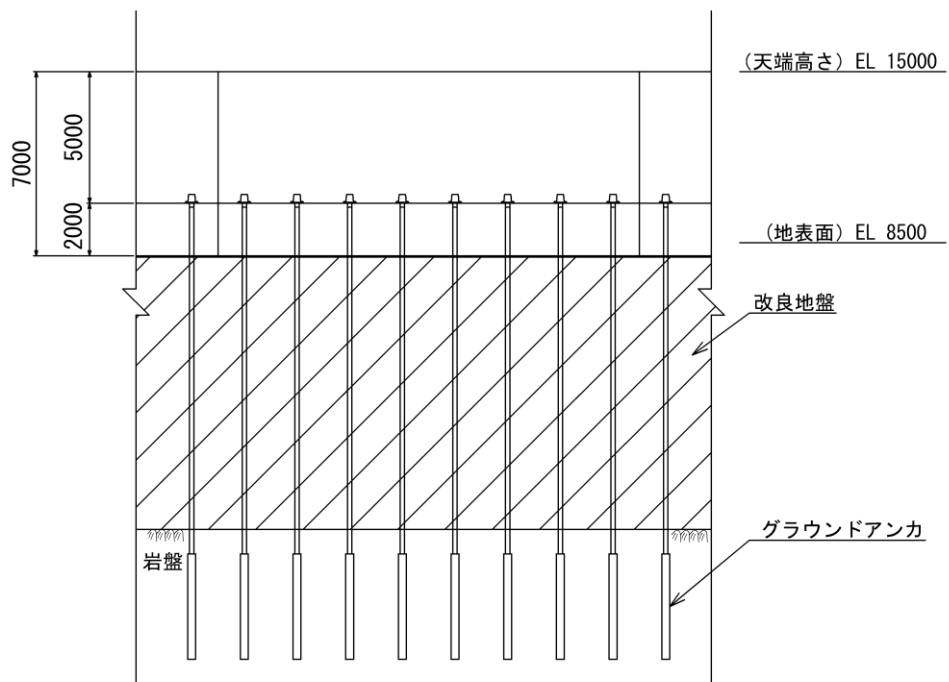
(1) 防波壁（逆 T 擁壁）の構造図（正面図）
